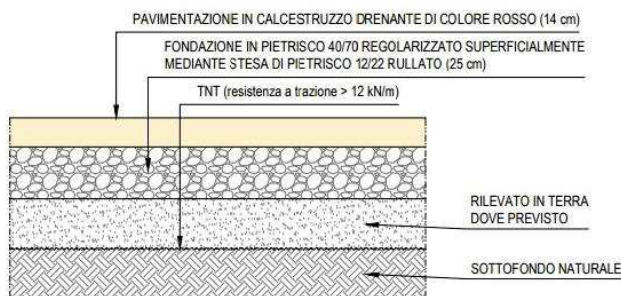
Dettaglio pavimentazione ciclabile in calcestruzzo drenante
